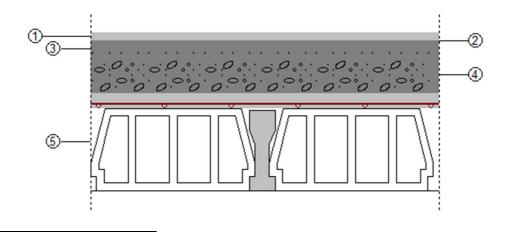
Detalle constructivo de cubierta plana transitable.43
